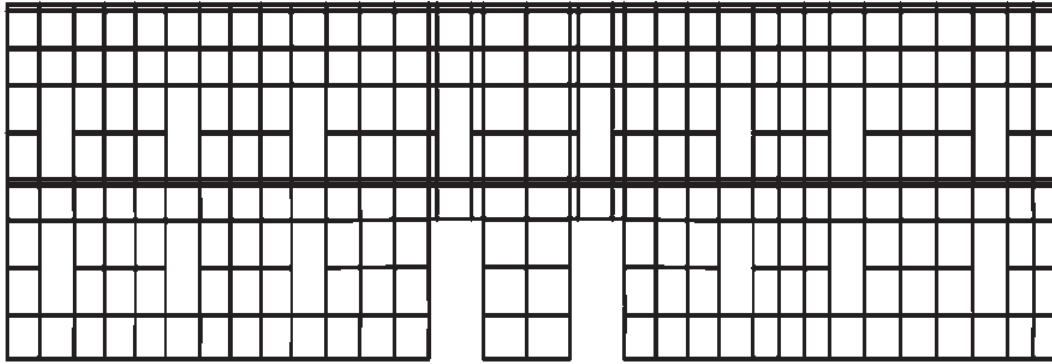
Modelo de elementos rígidos para la fachada norte.
